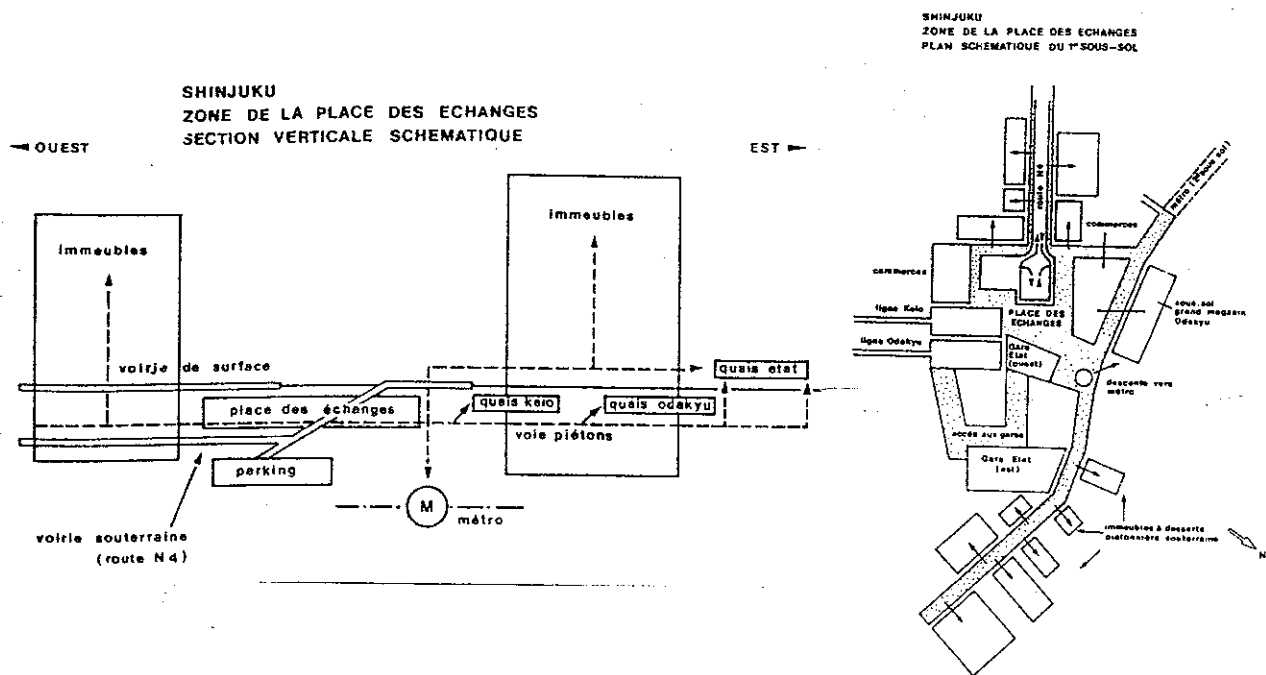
' : Plan schématique de l'espace d'échanges de la gare de Shinjuku
